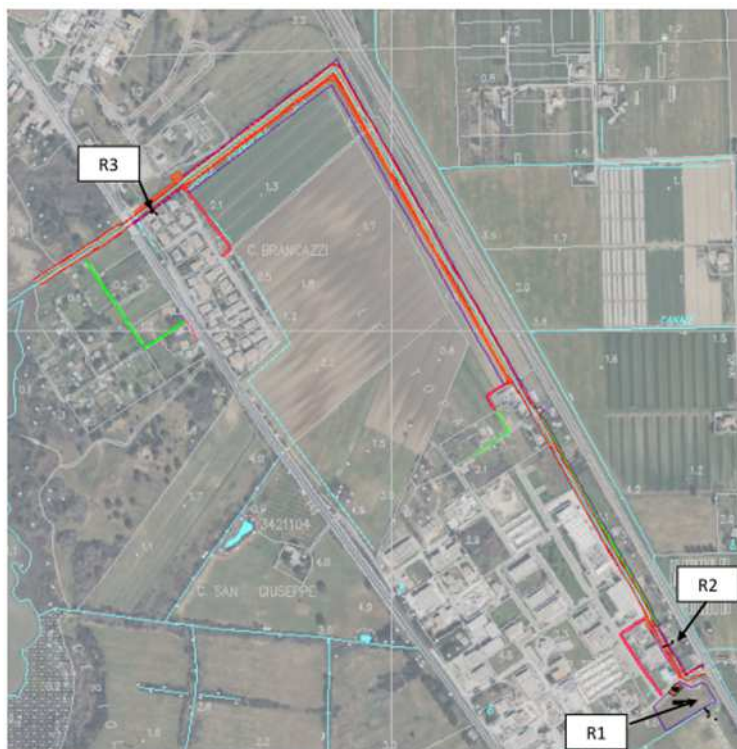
Individuazione sulla planimetria generale dei tre ricettori individuati
